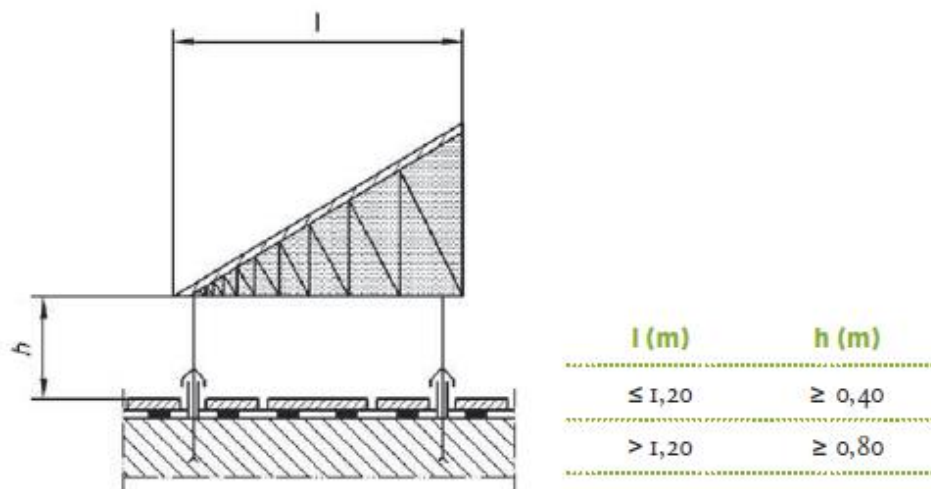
Hauteur minimale d'un équipement solaire rapportée à l'étanchéité d'une sur étanchéité de toiture (Recommandations professionnelles de la CFSE, 2011)
